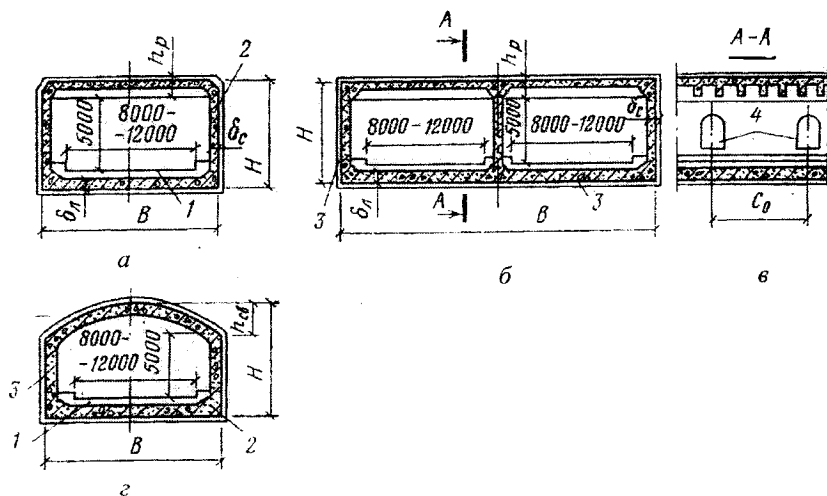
Конструкції транспортних тунелів з монолітного залізобетону:
